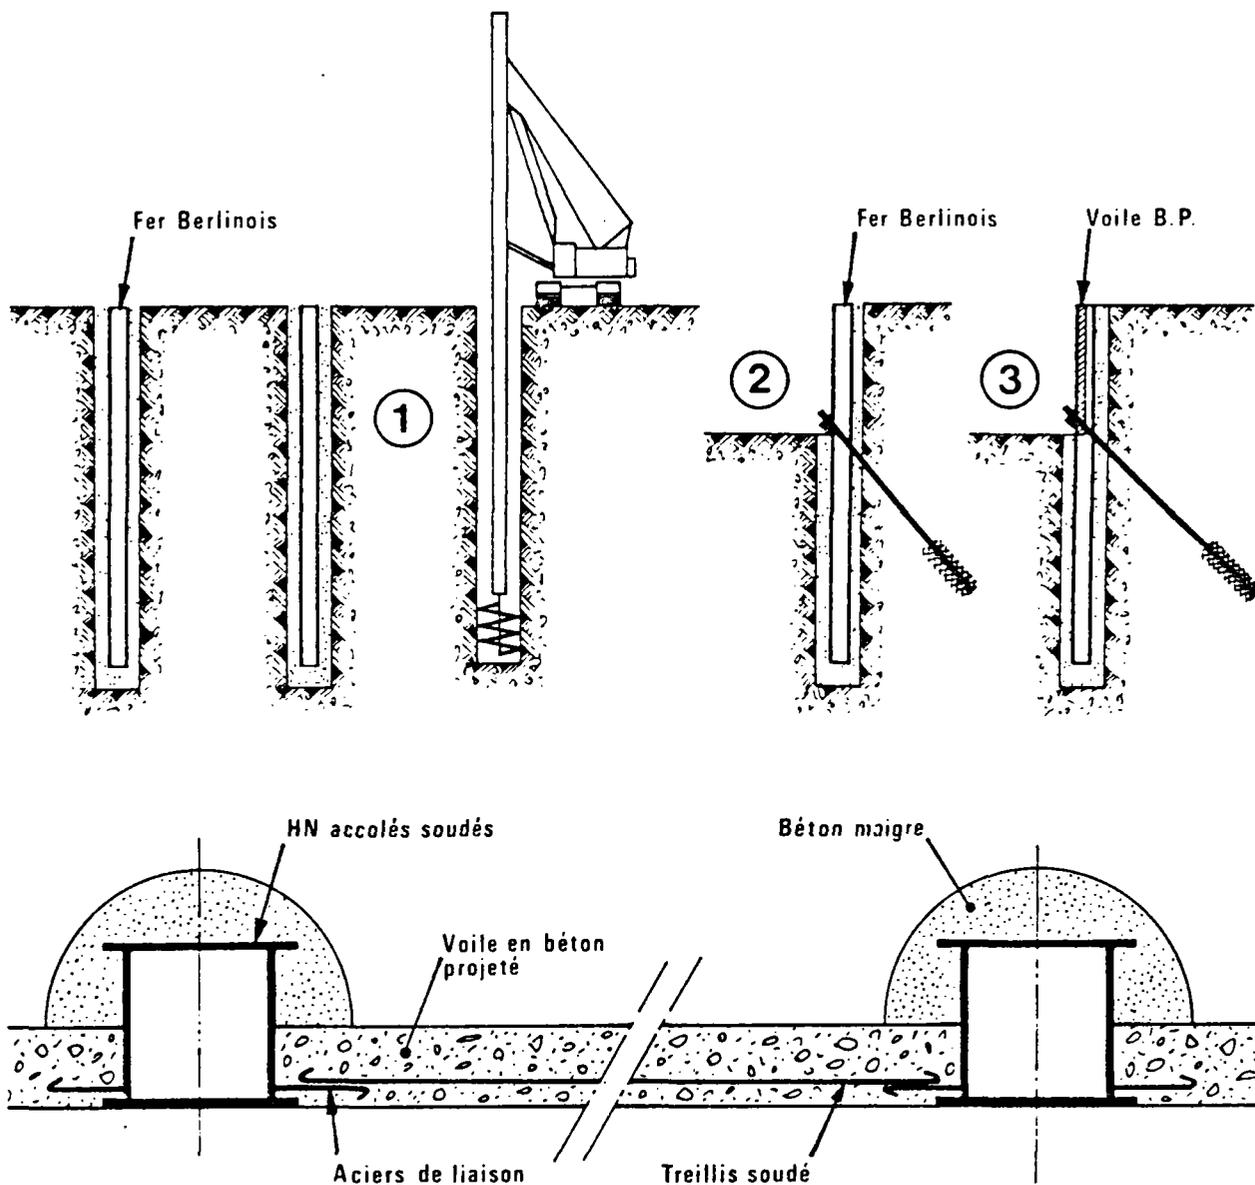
Exemple de soutènement par paroi berlinoise et béton projeté ancrée par une nappe de tirants précontraints.
